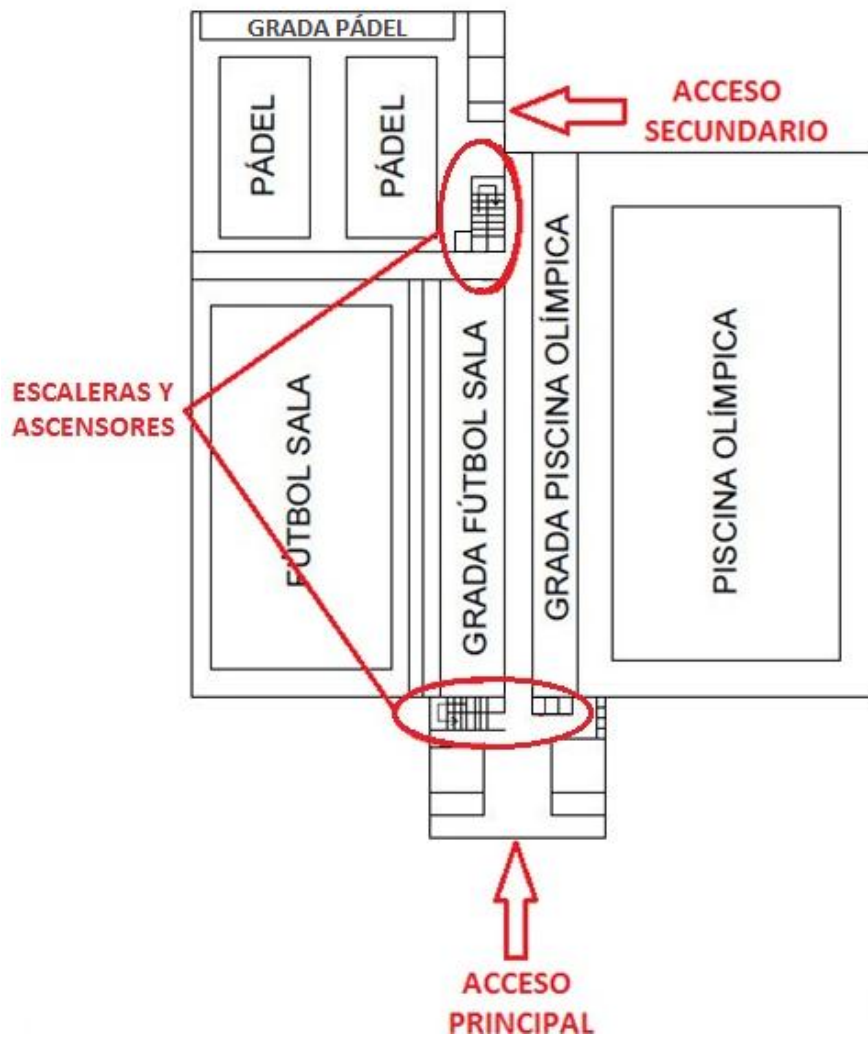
Distribución en planta de los accesos, escaleras y ascensores
